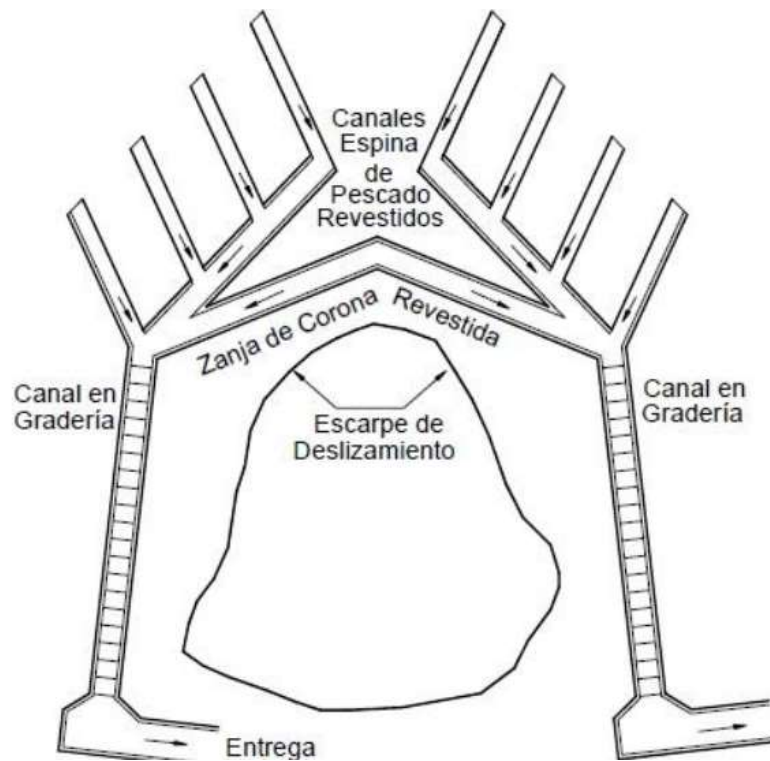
Esquema de planta de canales colectores espina de pescado con canales en gradería.
